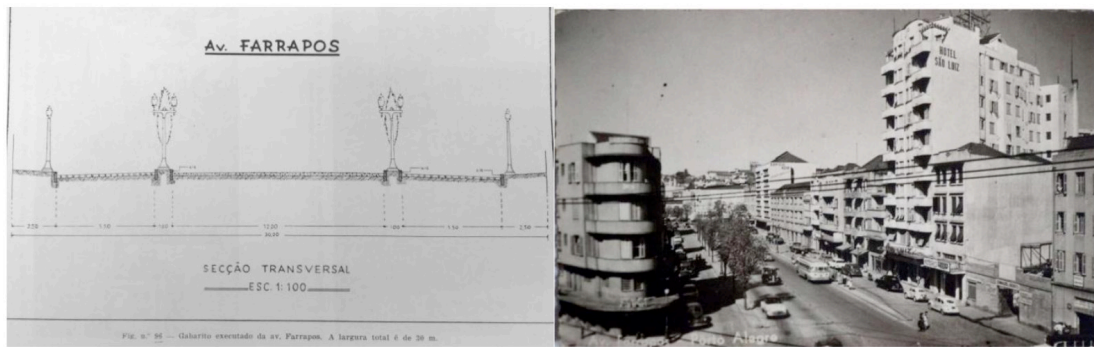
Perfil original da Avenida Farrapos- fonte: Loureiro da Silva,1943; características espaciais da Avenida Farrapos em foto de 1948.
